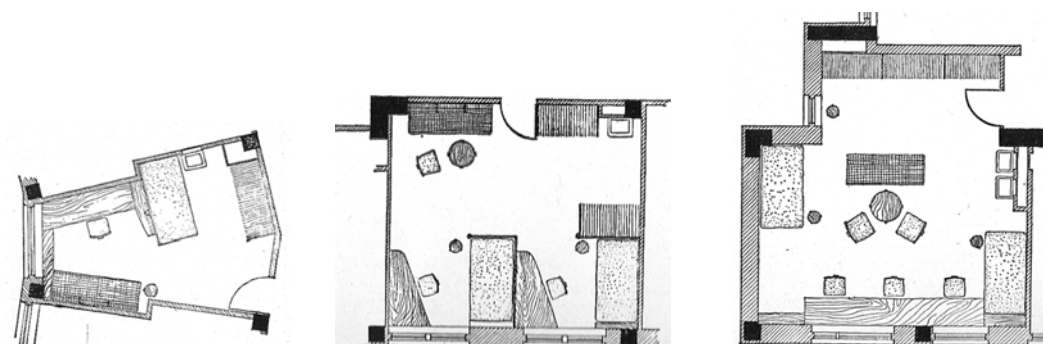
Baker House, solução definitiva, planta baixa tipo.
